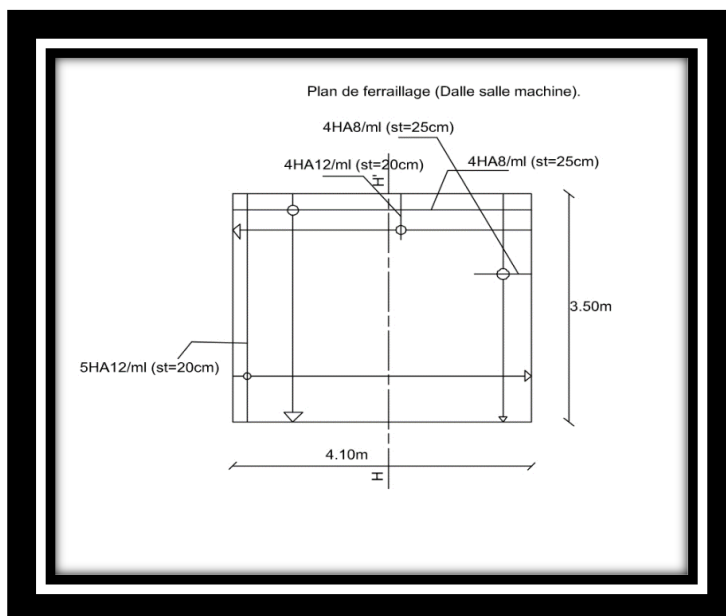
Plan de ferrailage (Dalle de la salle machine).
